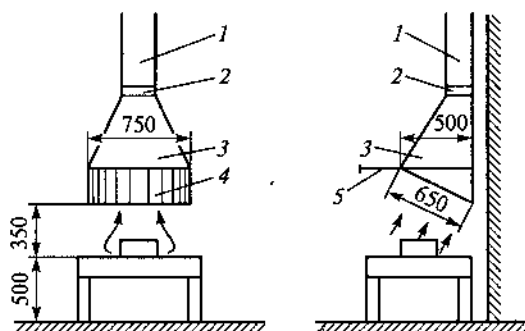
Схема отсоса газов, выделяющихся при сварке, от сварочного поста:
